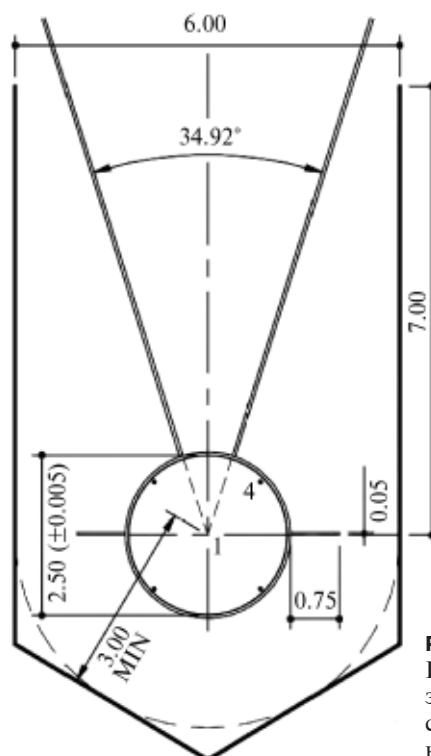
Конструкция заградительной сетки для метания диска
